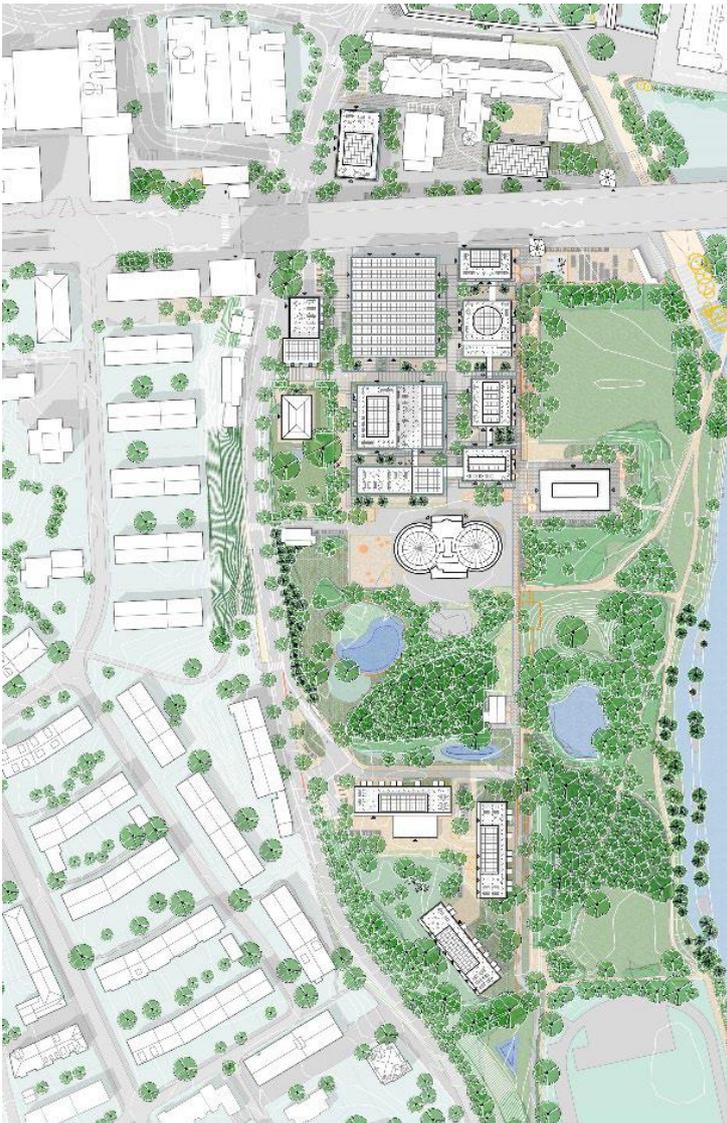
Situationsplan (Richtprojekt «Downtown Gastown» Seite 6)
